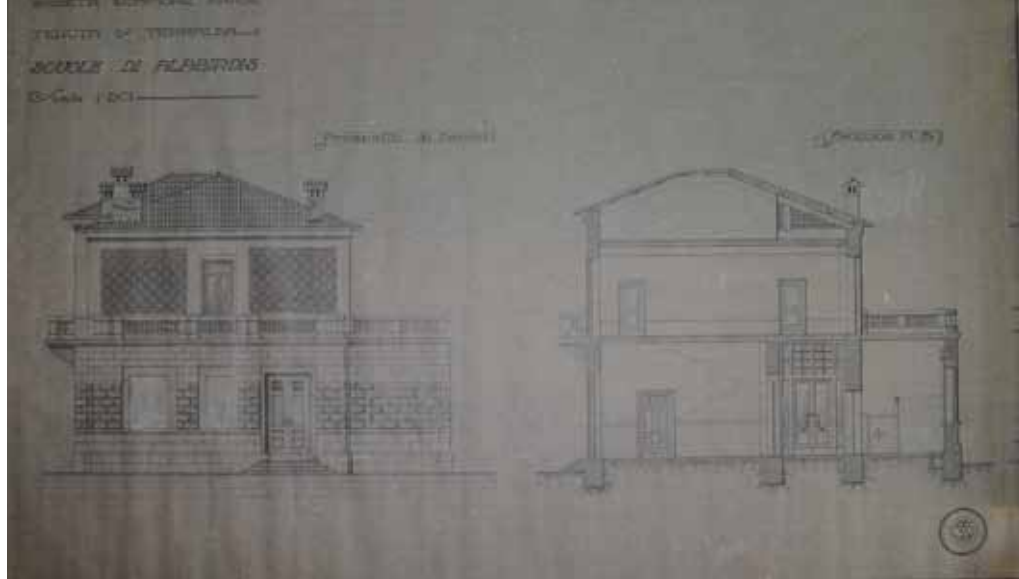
Le scuole di Alabirdis. Prospetto laterale e sezione trasversale
